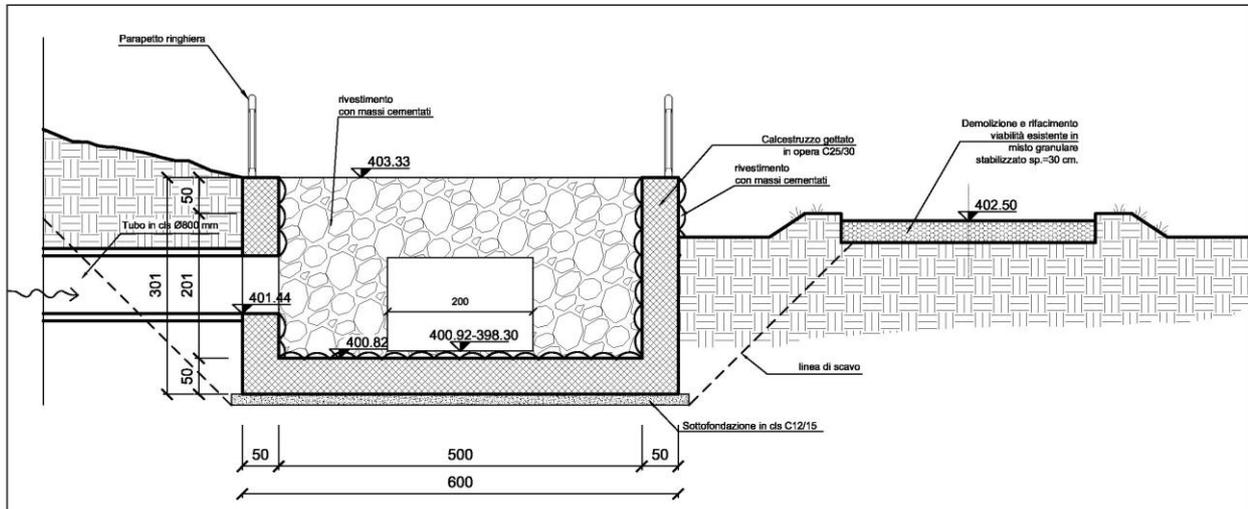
Sistema pluviario sud – Vasca Vs12 - pianta
